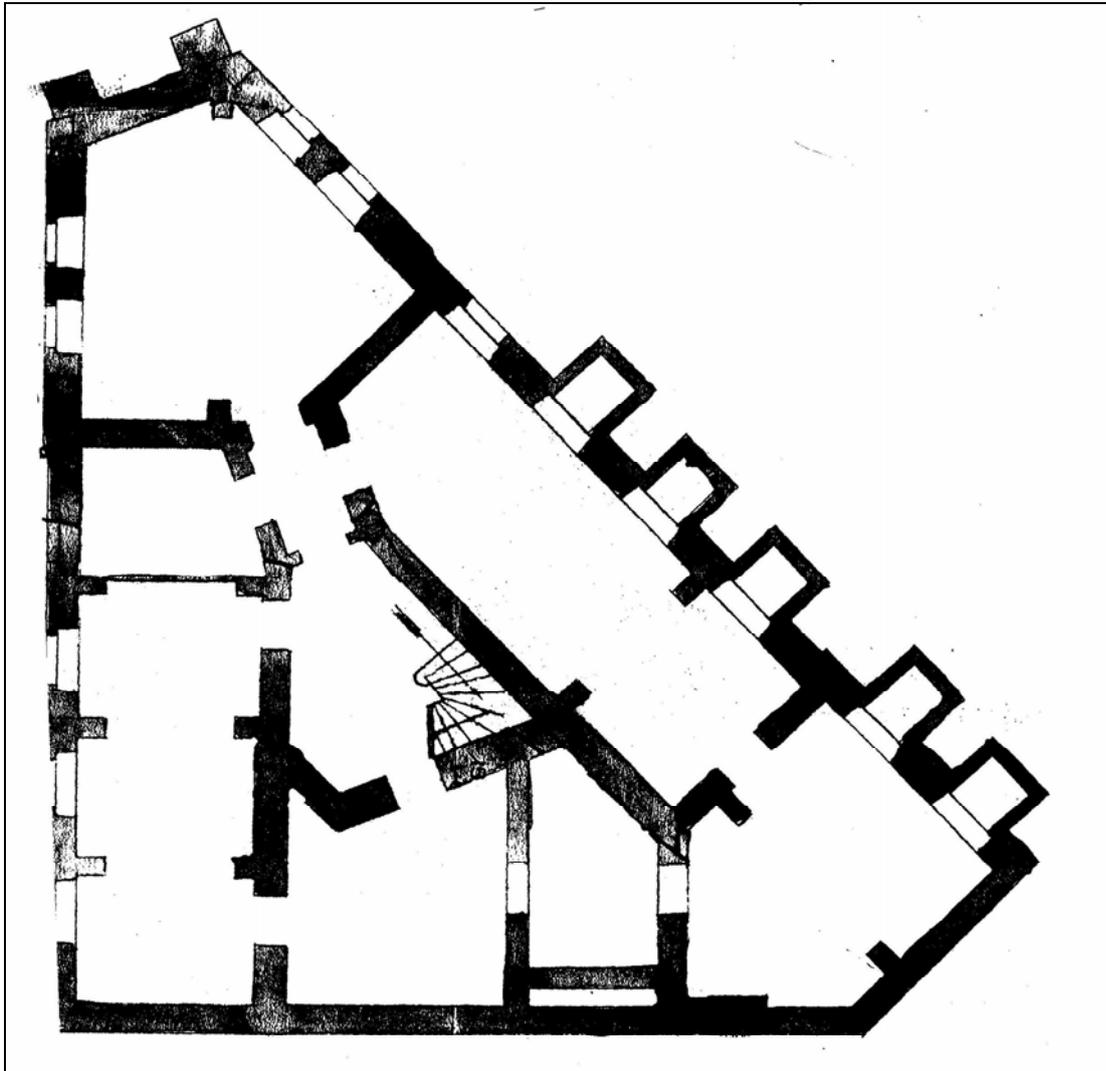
Grundriss eines Altbau-Kellergeschoßes (Beispiel)
